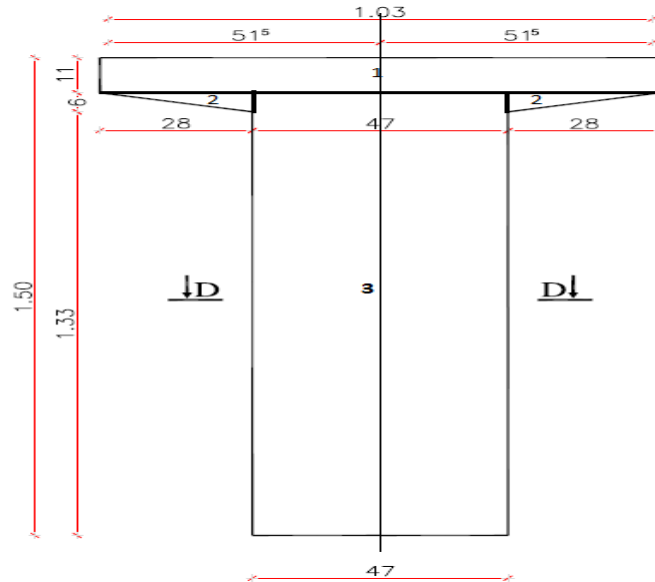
Section d'about de la poutre d'about sans hourdis.
